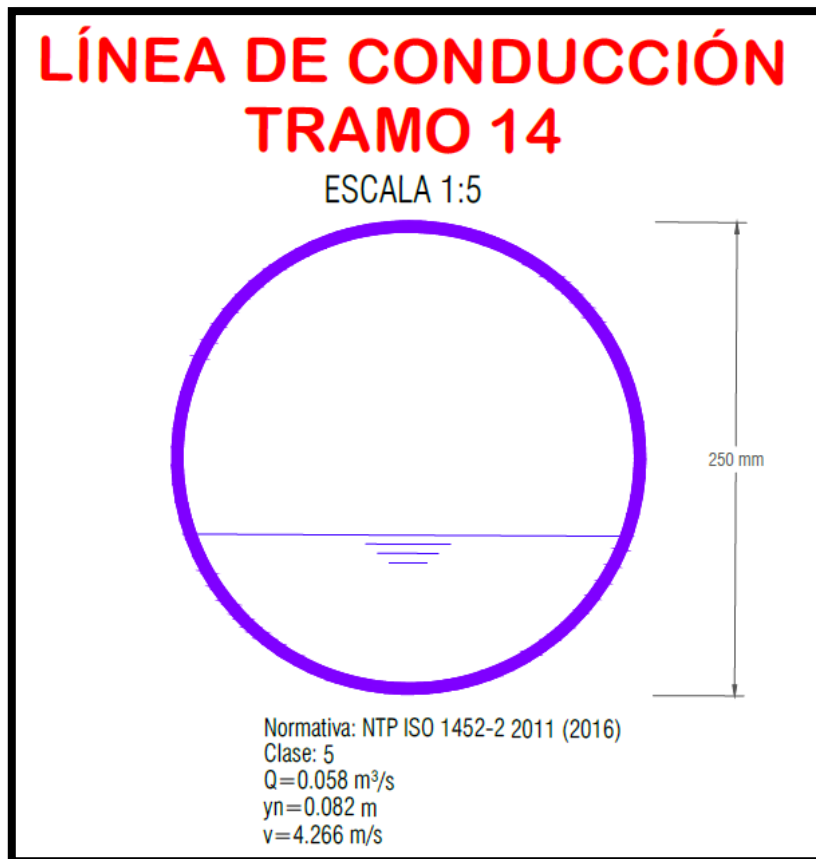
Sección típica de la tubería de PVC-U 250 mm, Tramo 14
